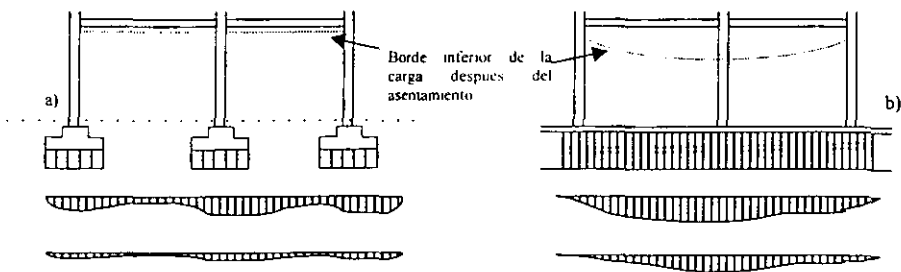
Distribución de las presiones dentro del suelo situado debajo de un edificio: a) apoyado sobre zapatas muy espaciadas entre sí; b) apoyado sobre losa de concreto. La presión unitaria que se transmite al suelo es la misma en ambos casos.
